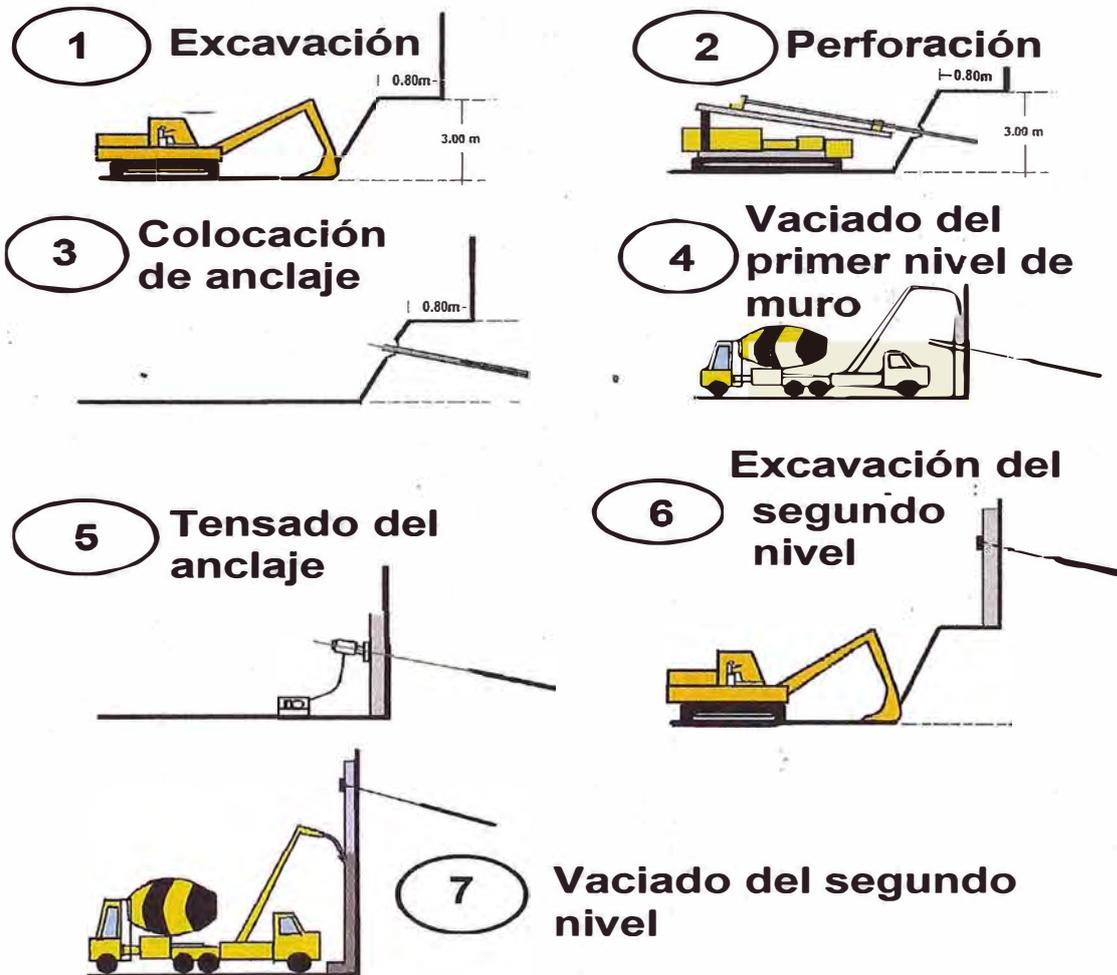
Secuencia de excavación, anclaje y construcción de muro pantalla anclada
